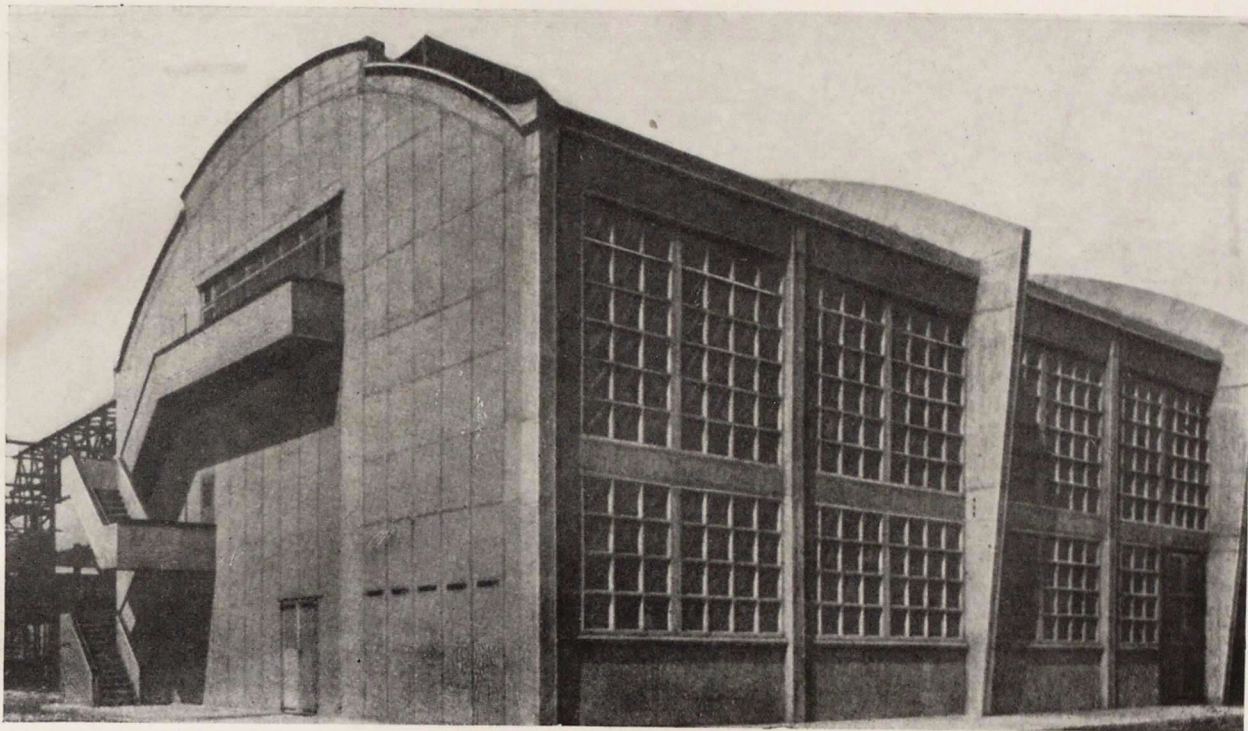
Архитектурное решение фасада производственного здания с железобетонными переплетами
